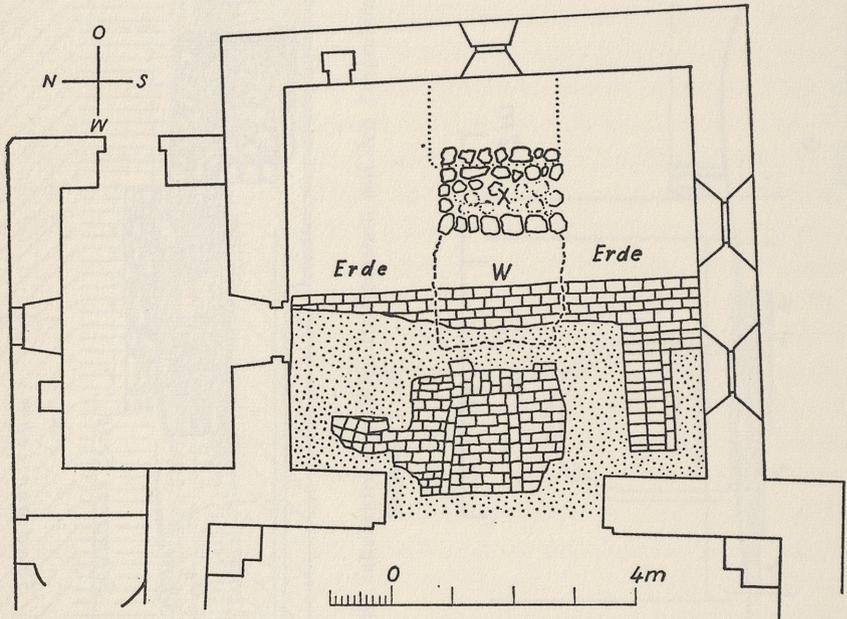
Grundriß des Presbyteriums und der Sakristei der Jakobskirche in Wien-Heiligenstadt mit der Mauerbank X und dem barocken Fußboden (Estrich und Ziegelbelag). Maßstab 1 : 125.
